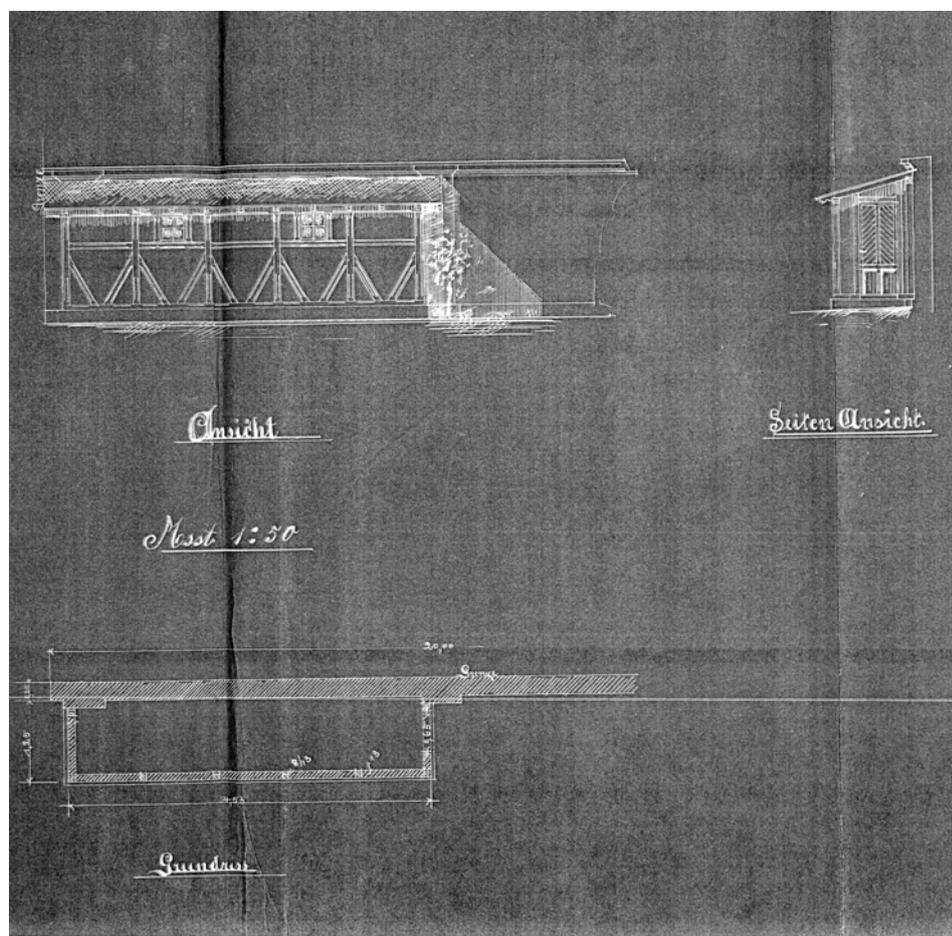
Planzeichnung H. Plange, Hühnerstall, 1897
